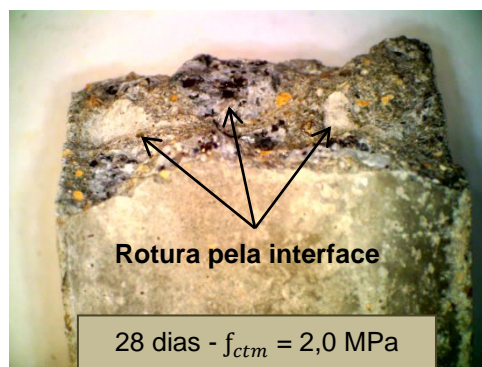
Superfície de fractura de provete com Brita granítica ensaiado à tracção axial (superfícies de fractura envolvendo maioritariamente a ITZ)
